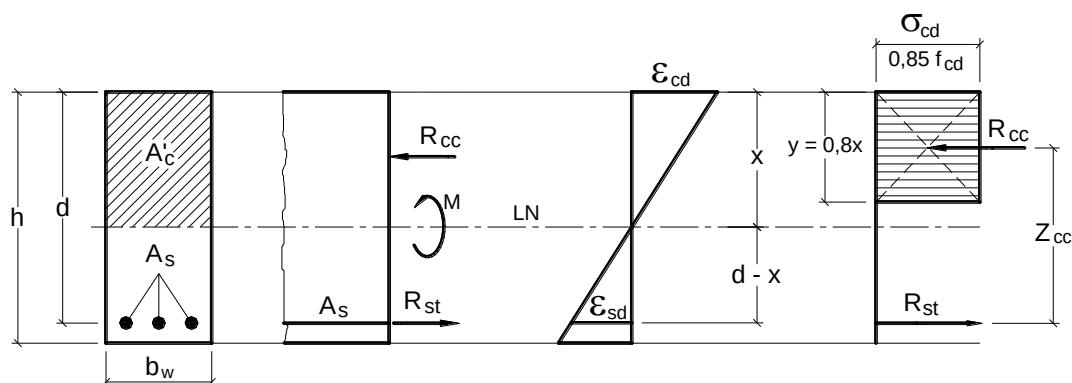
Distribuição de tensões e deformações em viga de seção retangular com armadura simples, para concretos do Grupo I.
